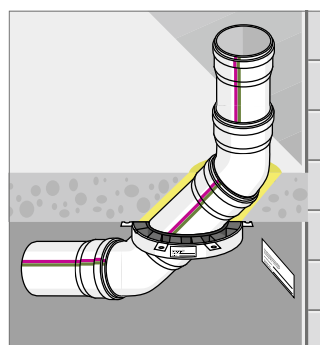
Угловая противопожарная манжета (только для накладывания на перекрытие)
